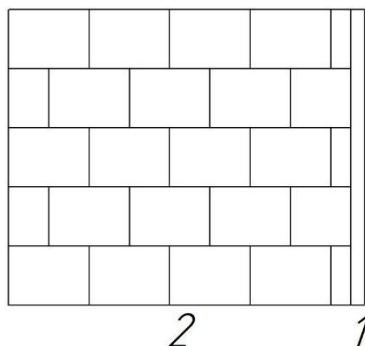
Эскиз наружной стены до реконструкции
